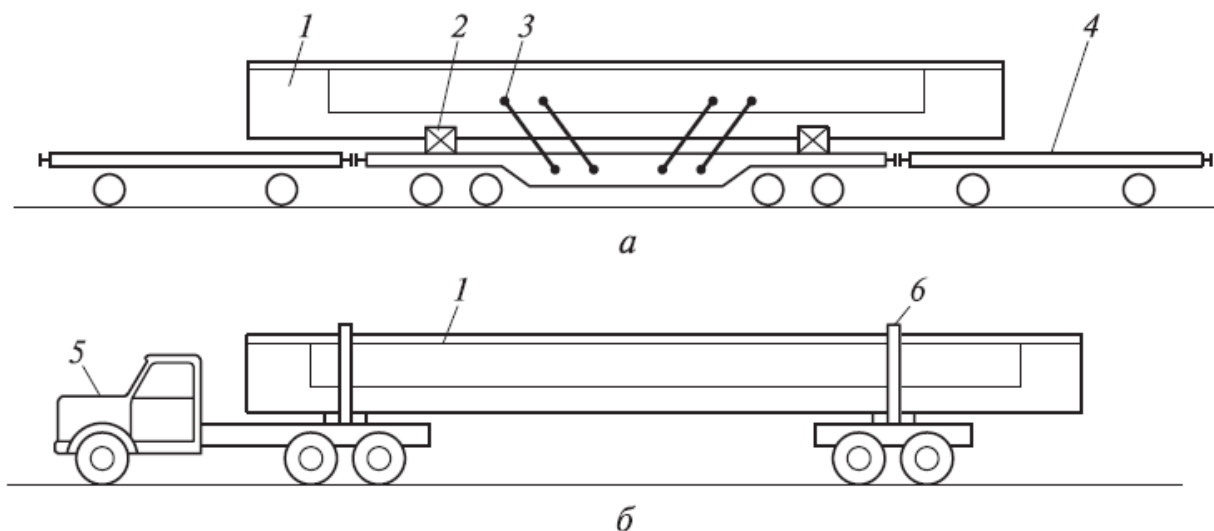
Перевозка конструкций по железным и автомобильным дорогам:
